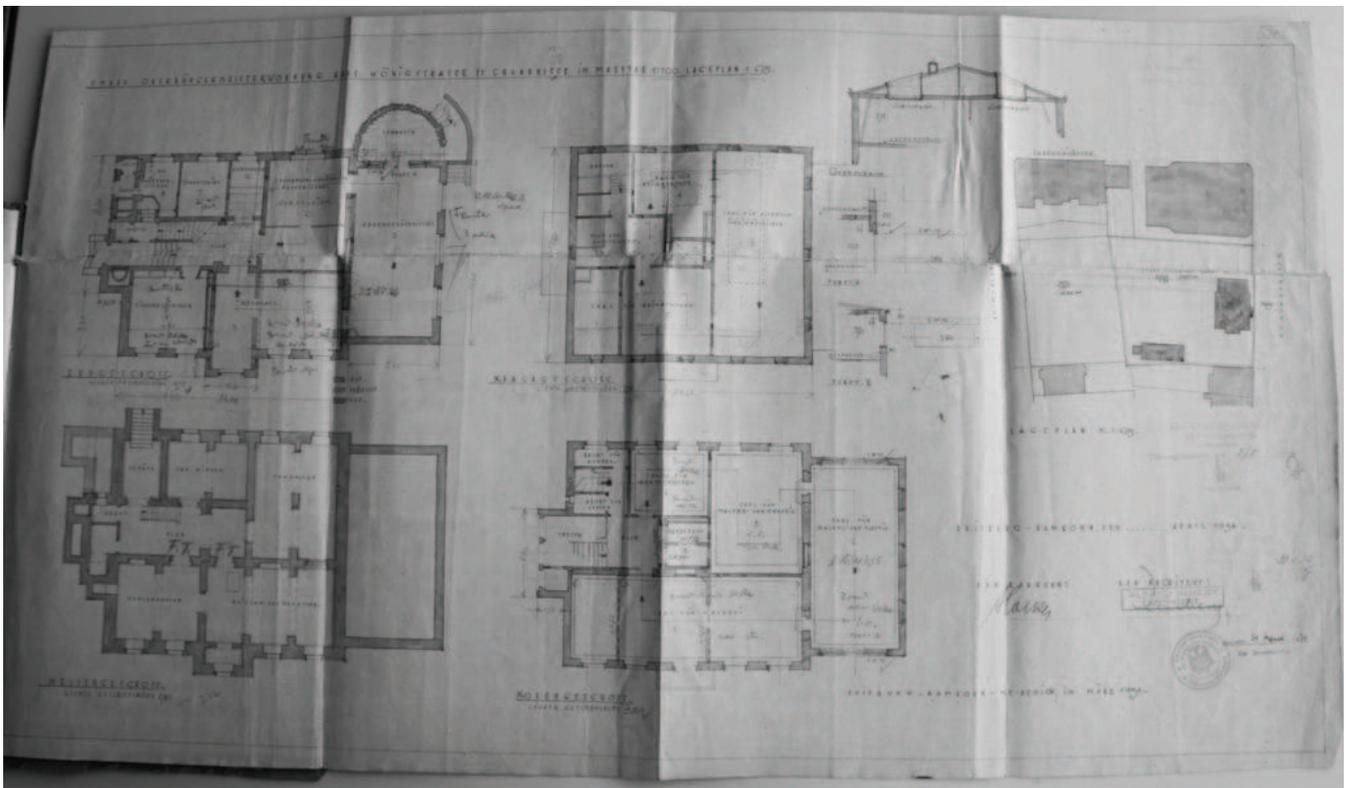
Alfred Imbery, Plan zum Umbau Königstr. 21, März 1934, M.: 1: 100 (StADu 610/ 4056)
